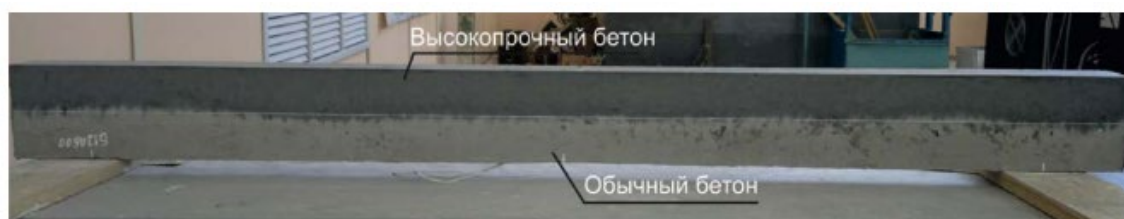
Общий вид железобетонной балки с высокопрочным бетоном в сжатой зоне
